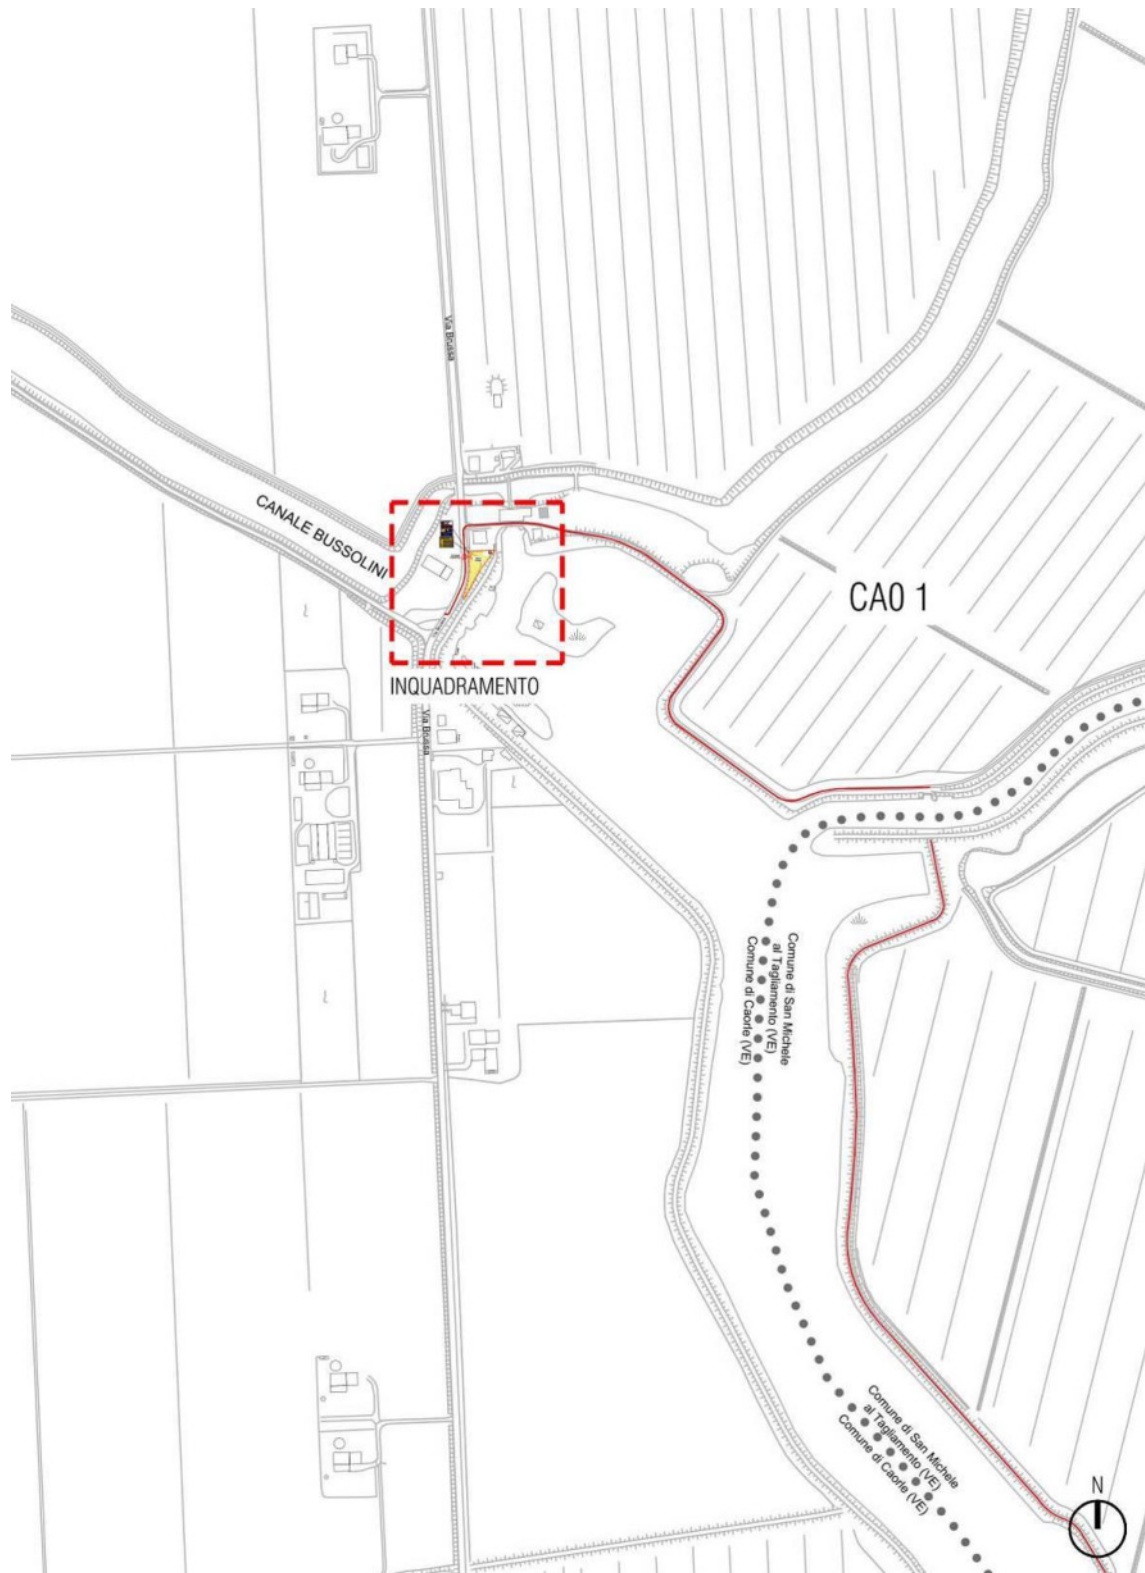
Individuazione area di cantiere nell'ambito della Brussa (Caorle).
